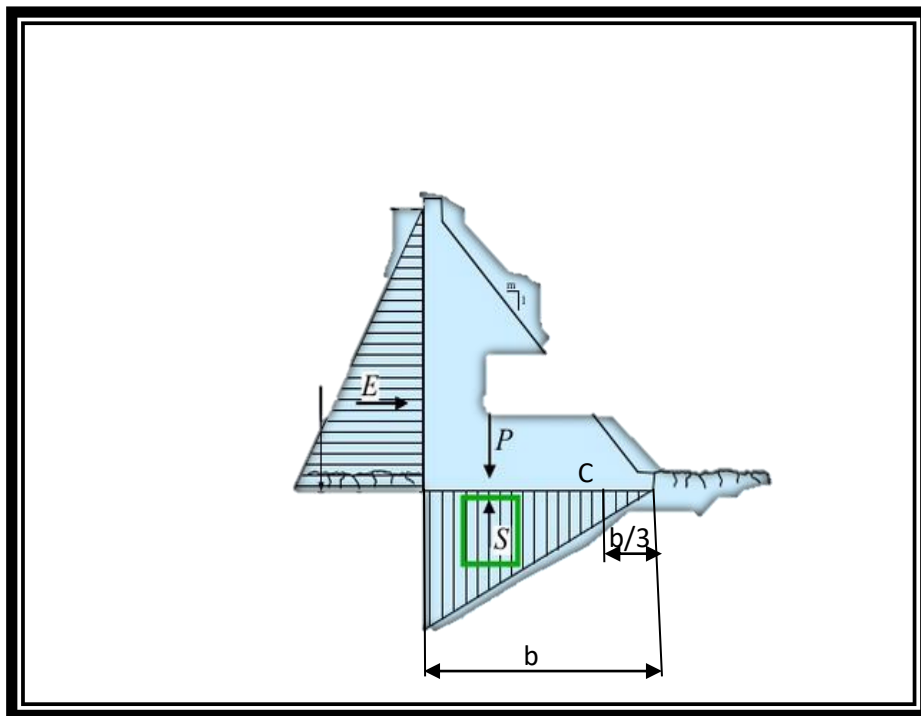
forces dues au poids propre P, à la poussée de l'eau E et à la sous-pression S agissant sur le barrage auxquelles s'oppose
